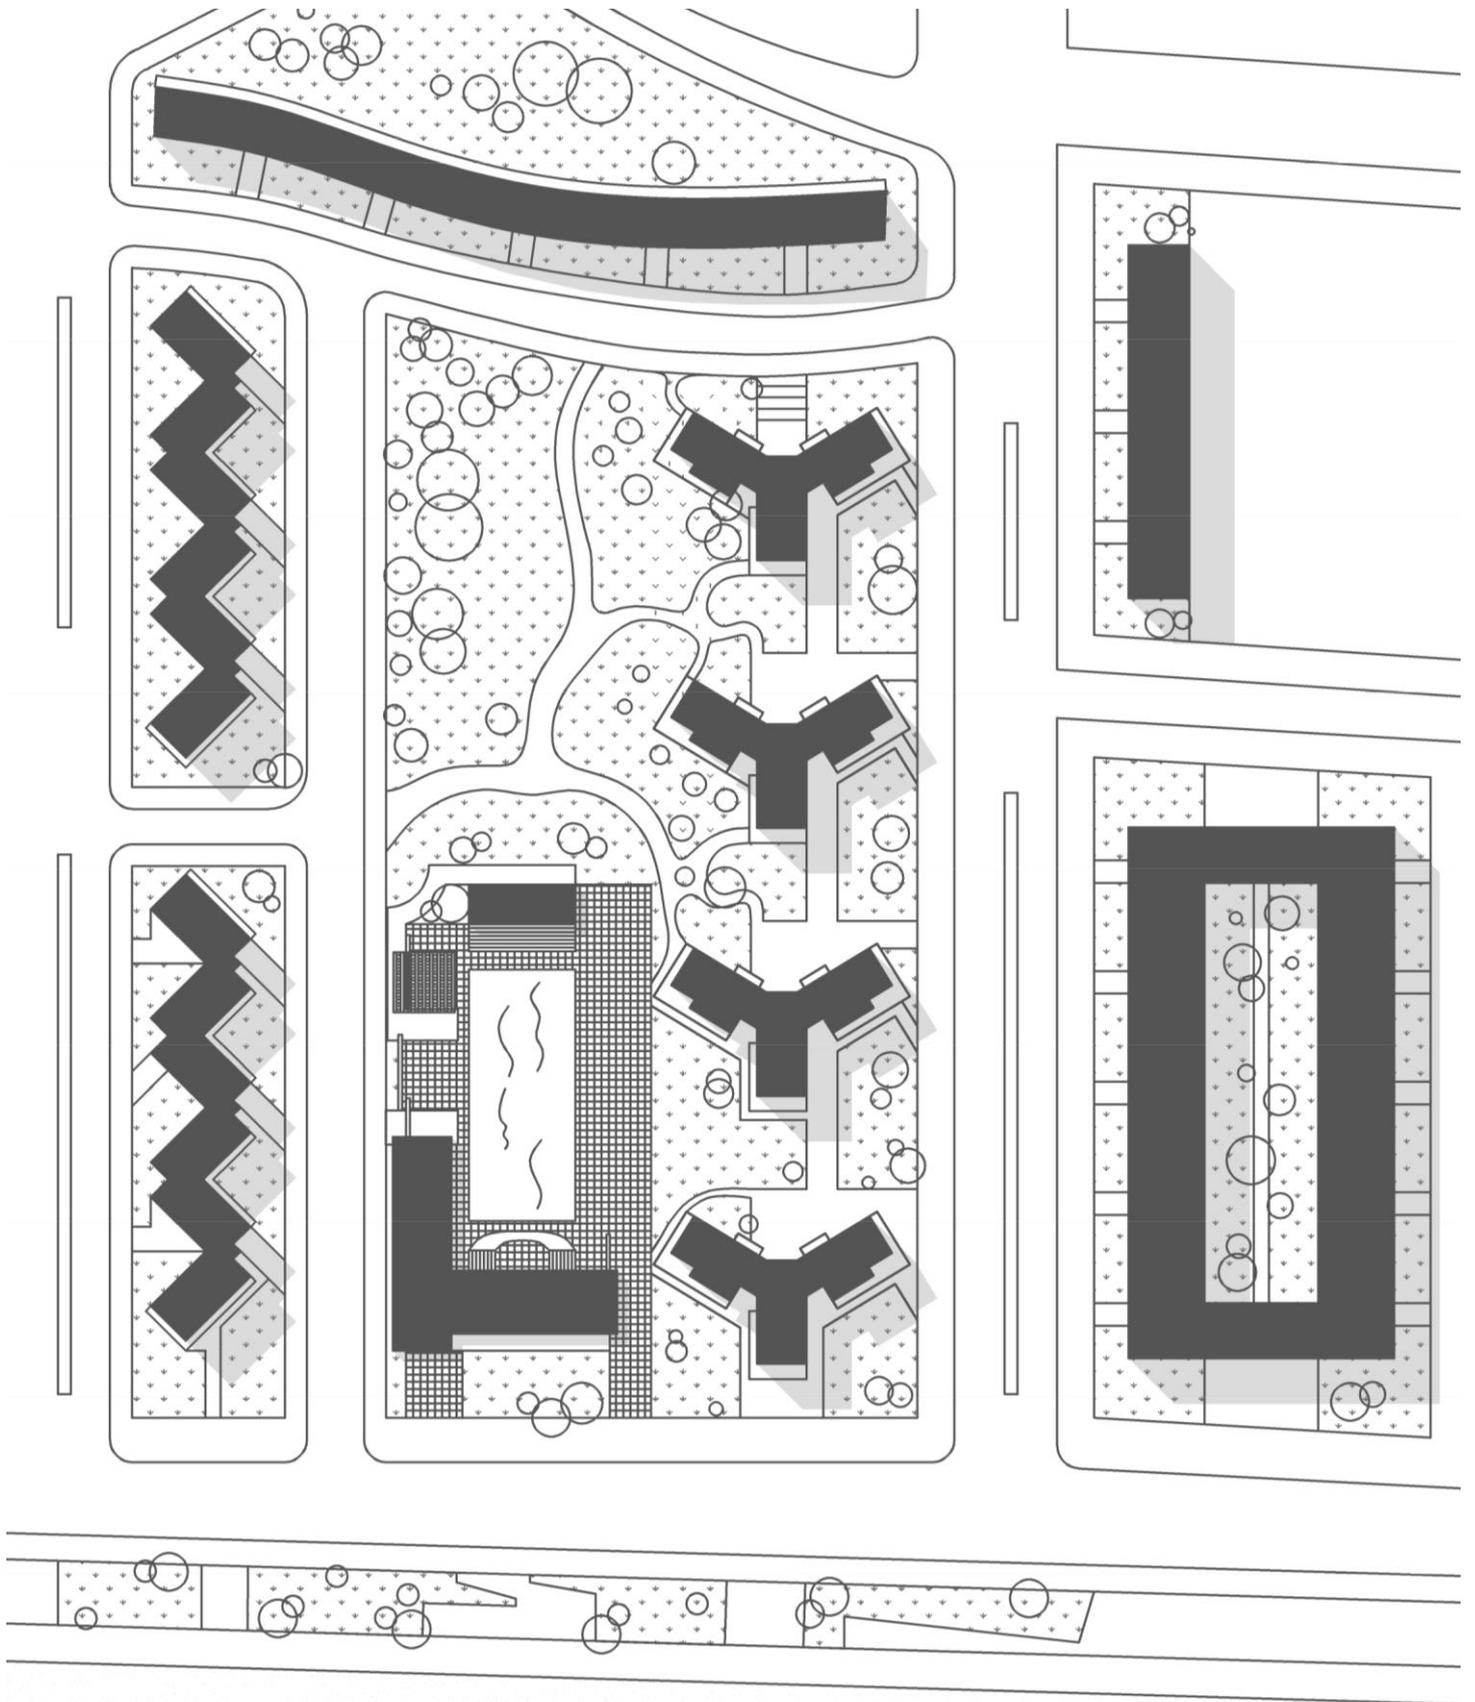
Planta del conjunto 1/1000, Proyecto finalmente realizado 1965. Elaboración propia.
